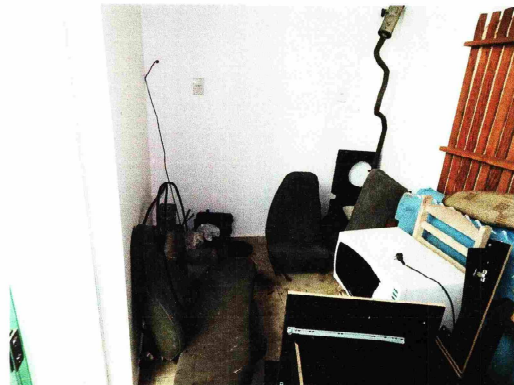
VISTA INTERNA FUNDOS ÁREA DE SERVIÇO + DESPEJO + LAVANDERIA
